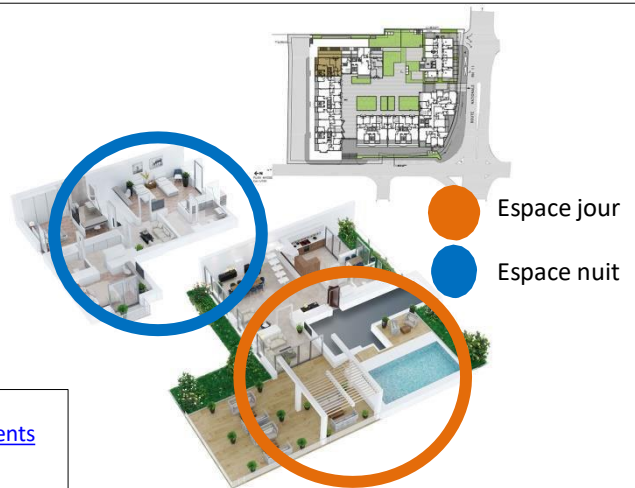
Plan et la 3d intérieure d'une duplexe F5
